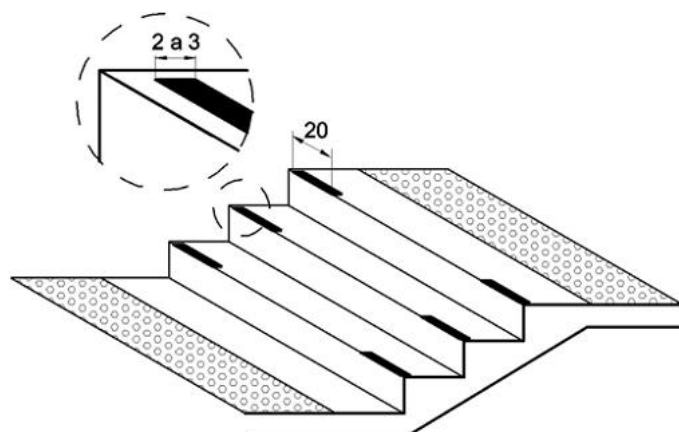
Detalhamento sinalização tátil no piso da escada.
